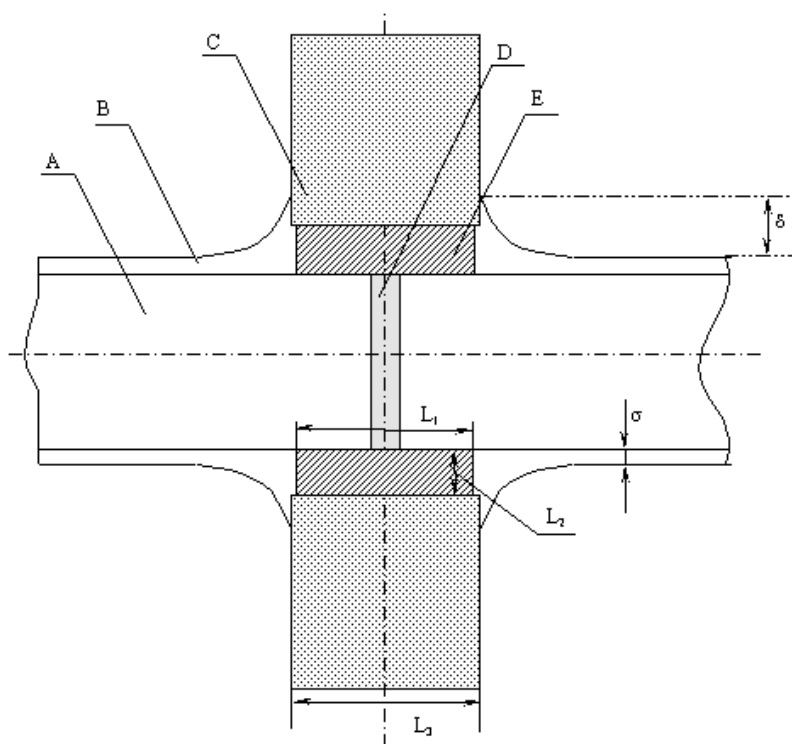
Конструкция узла пересечения воздуховода с ограждающей конструкцией
